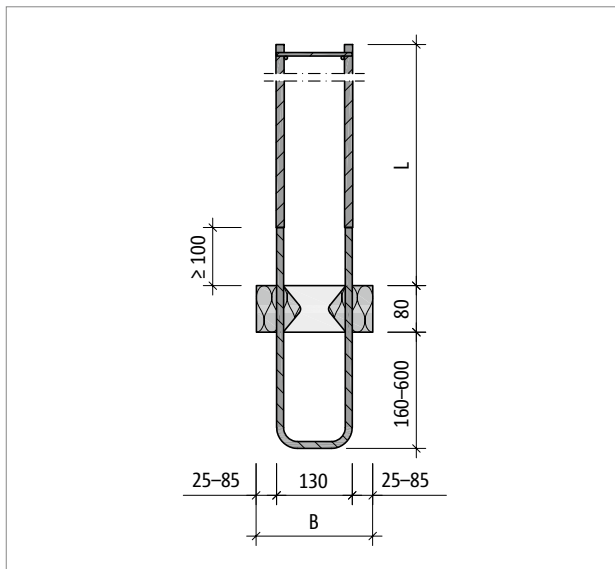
Schöck Sconnex® Typ W-N1T1-BW/BS: Produktschnitt A-A
